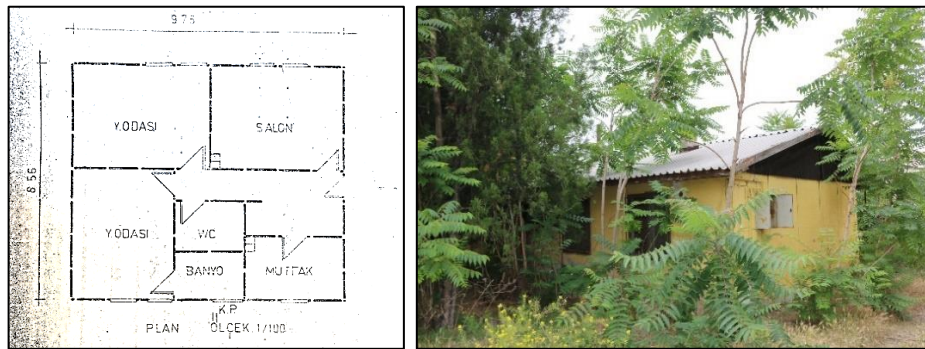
Prefabrik Yapıların Vaziyetini Gösterir Plan (TCDD).
